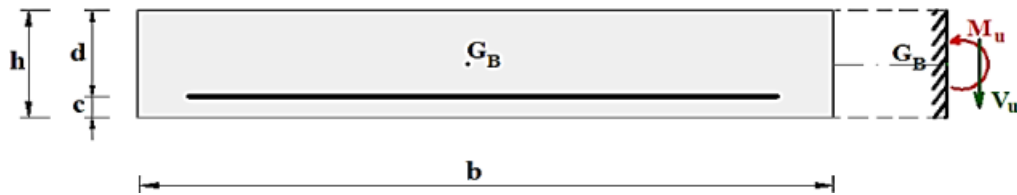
Les dimensions de ferrailage pour 1 bande
